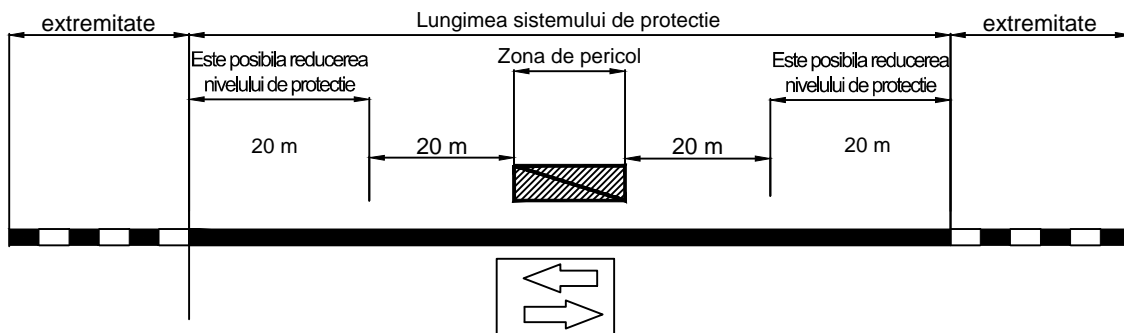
Lungimi minime ale parapetelor de siguranta la drumuri cu o banda pe sens
